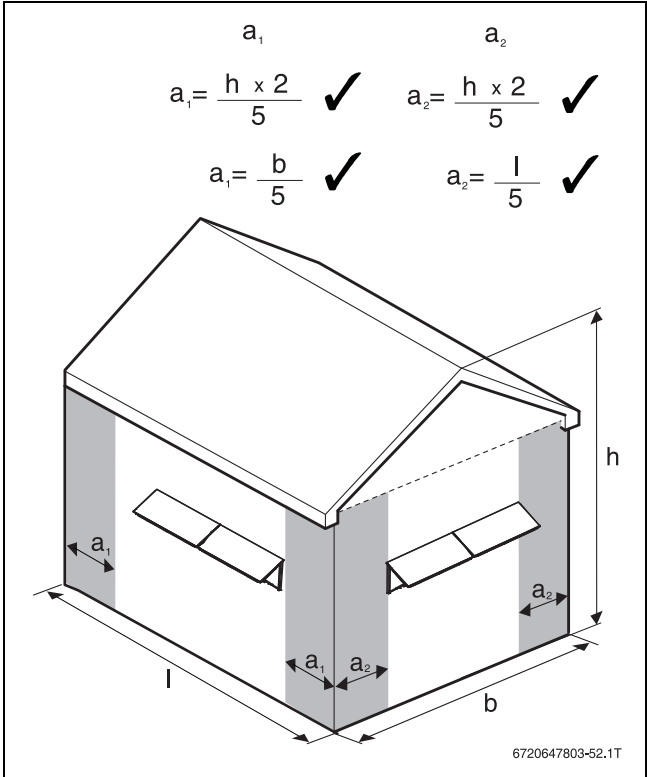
Einzuhaltende Abstandsmaße, Fassade
